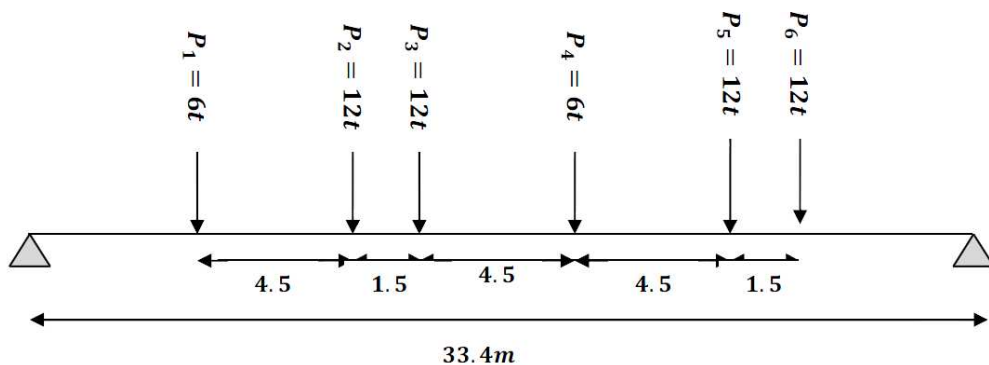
système B_c disposition de deux camions sur la chaussée (sens longitudinal)
